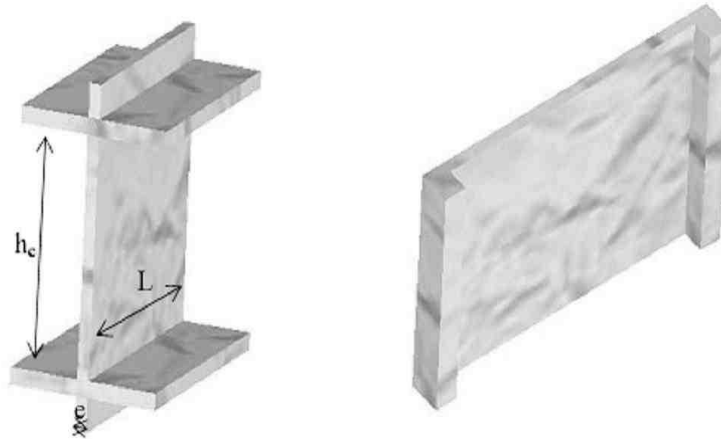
Schéma et dimensions des voiles (Coupe de voile en élévation.).
